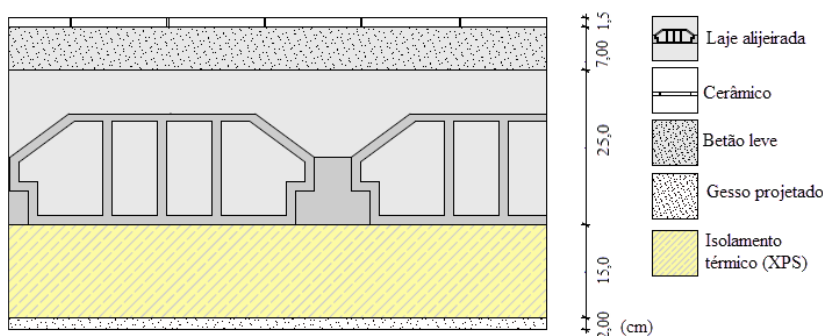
Solução construtiva de pavimento sobre locais não aquecidos
